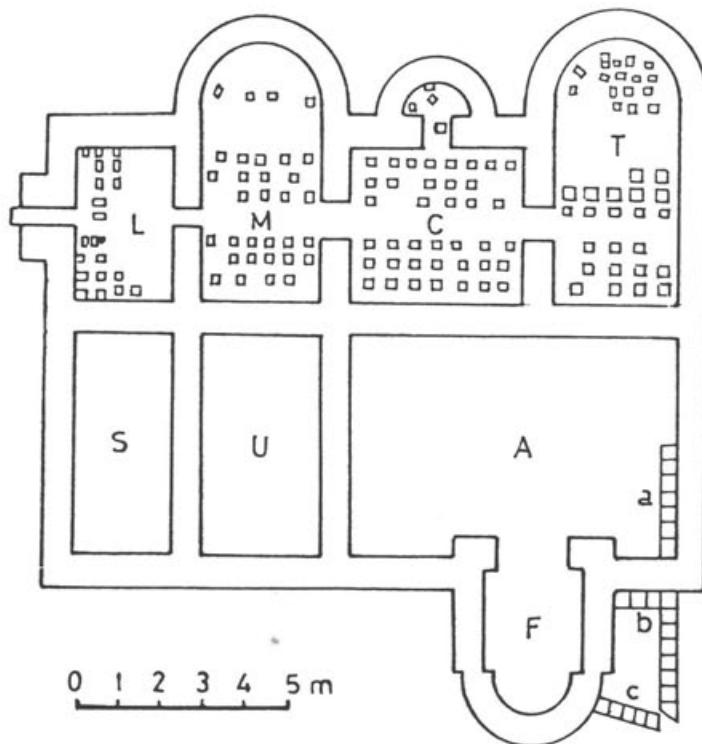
Slăveni, Plan des Bades (nach D. Tudor).
